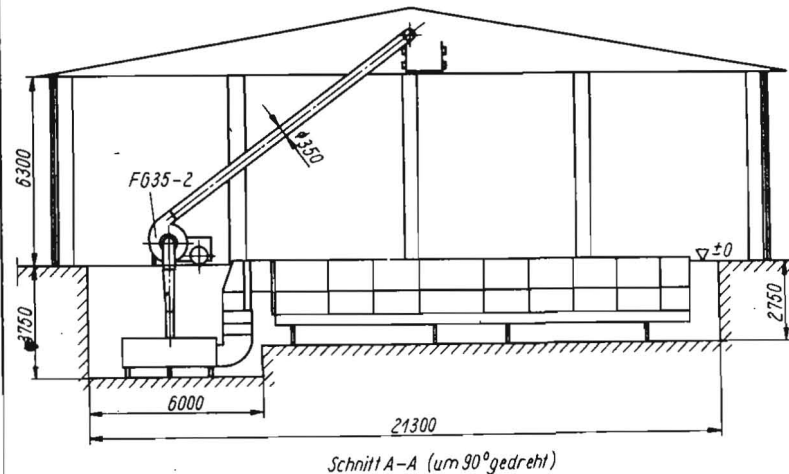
Strohzwischenlager unter Dach (Ausstattungsvariante 2)
